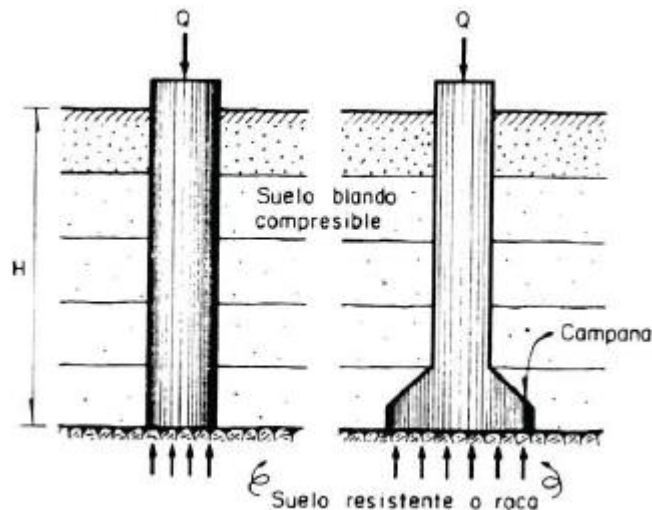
Pilas de punta, Manual de diseño y construcción de pilas y pilotes, SMMS, 1983.
